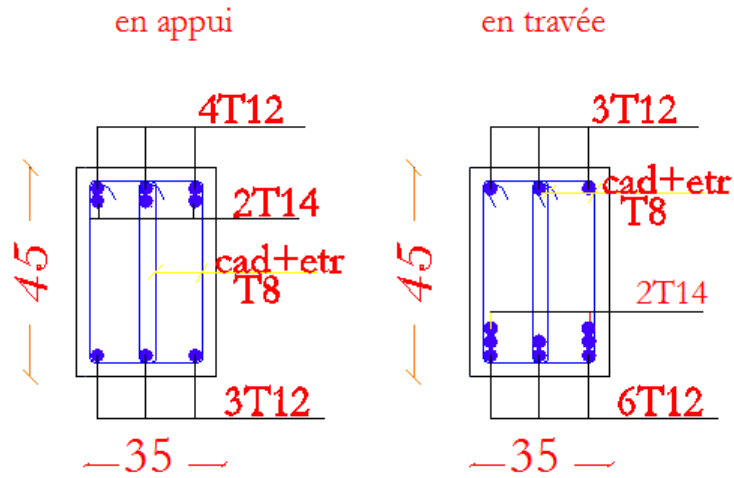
Ferrailage en appui et en travée de la poutre principale
